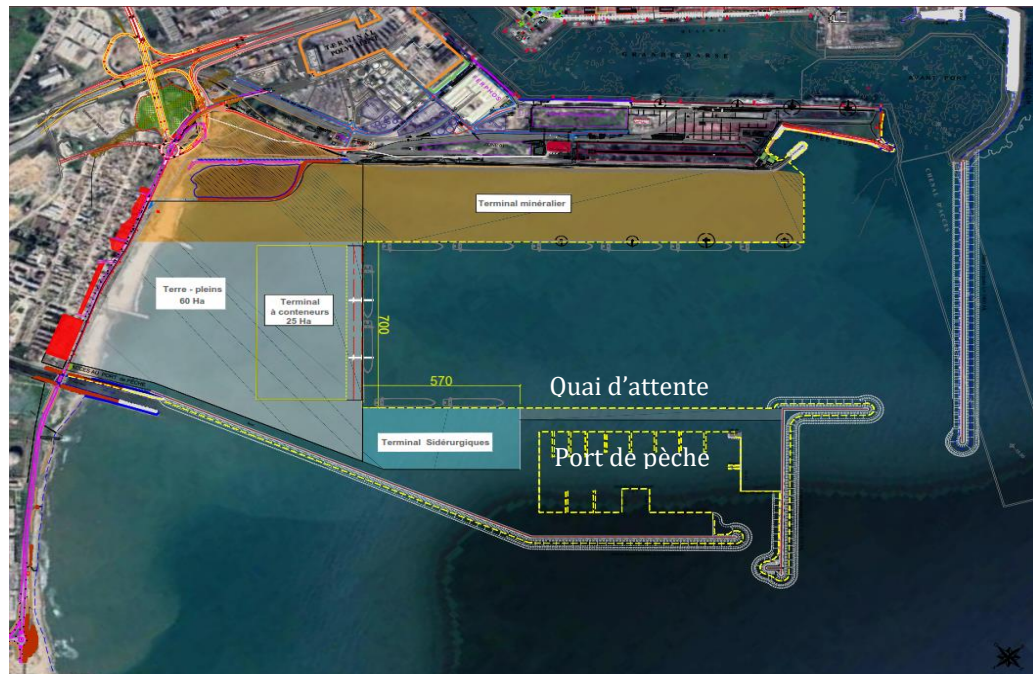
le plan de la nouvelle extension du port avec tous les nouveaux projets à concevoir sur le dock flottant
